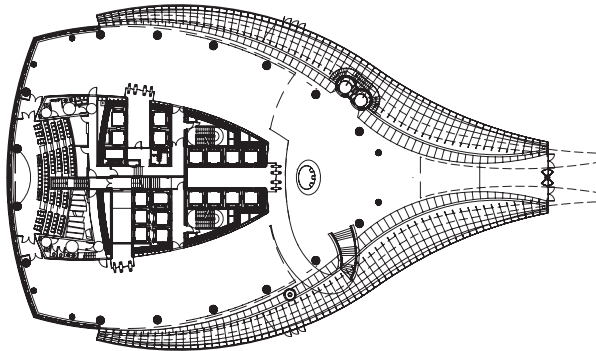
Planta tipo (Fuente: Torre Iberdrola).
